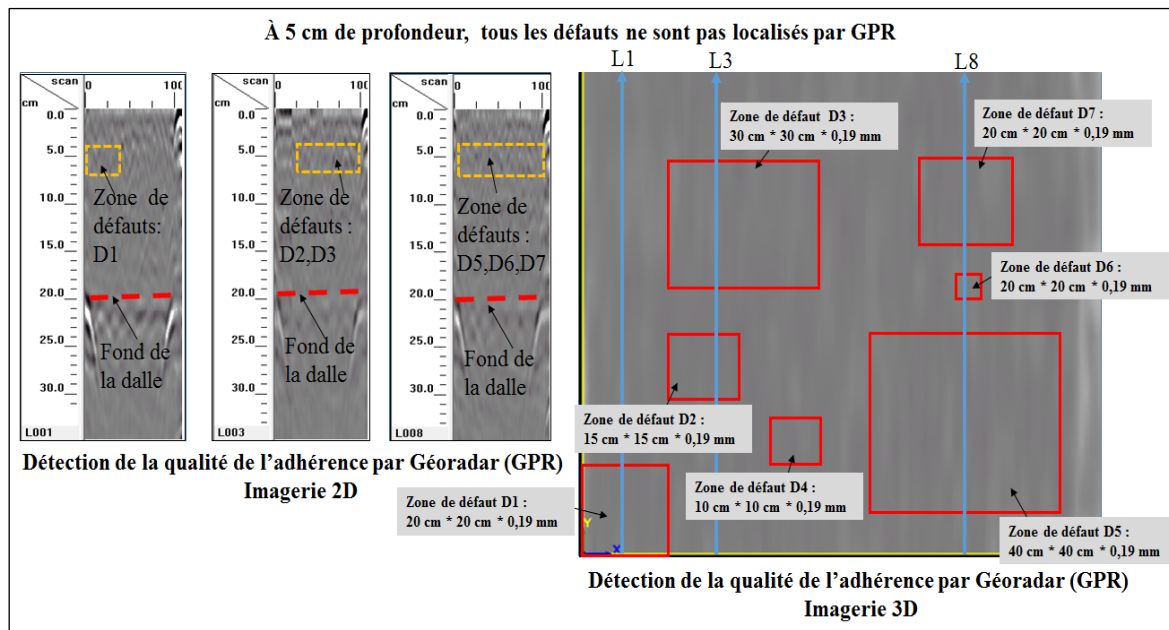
Détection de la qualité de l'adhérence par Géoradar (GPR) – Défaut placé à 5 cm de profondeur de la dalle - Dalle N° 5.
